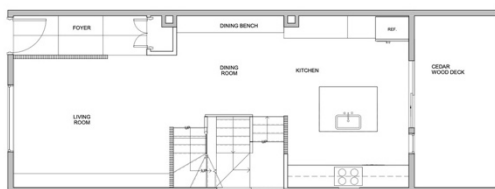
Torrens House, Planta Rés de Chão<sup>10</sup>
